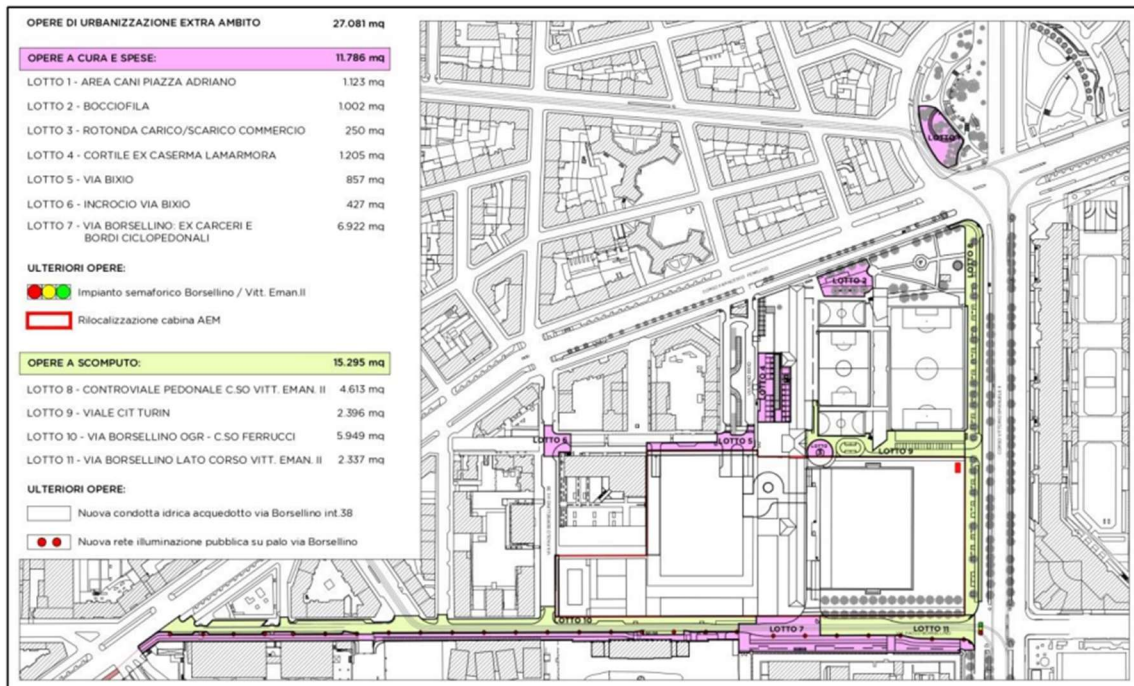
Opere di urbanizzazione planimetria generale di progetto
